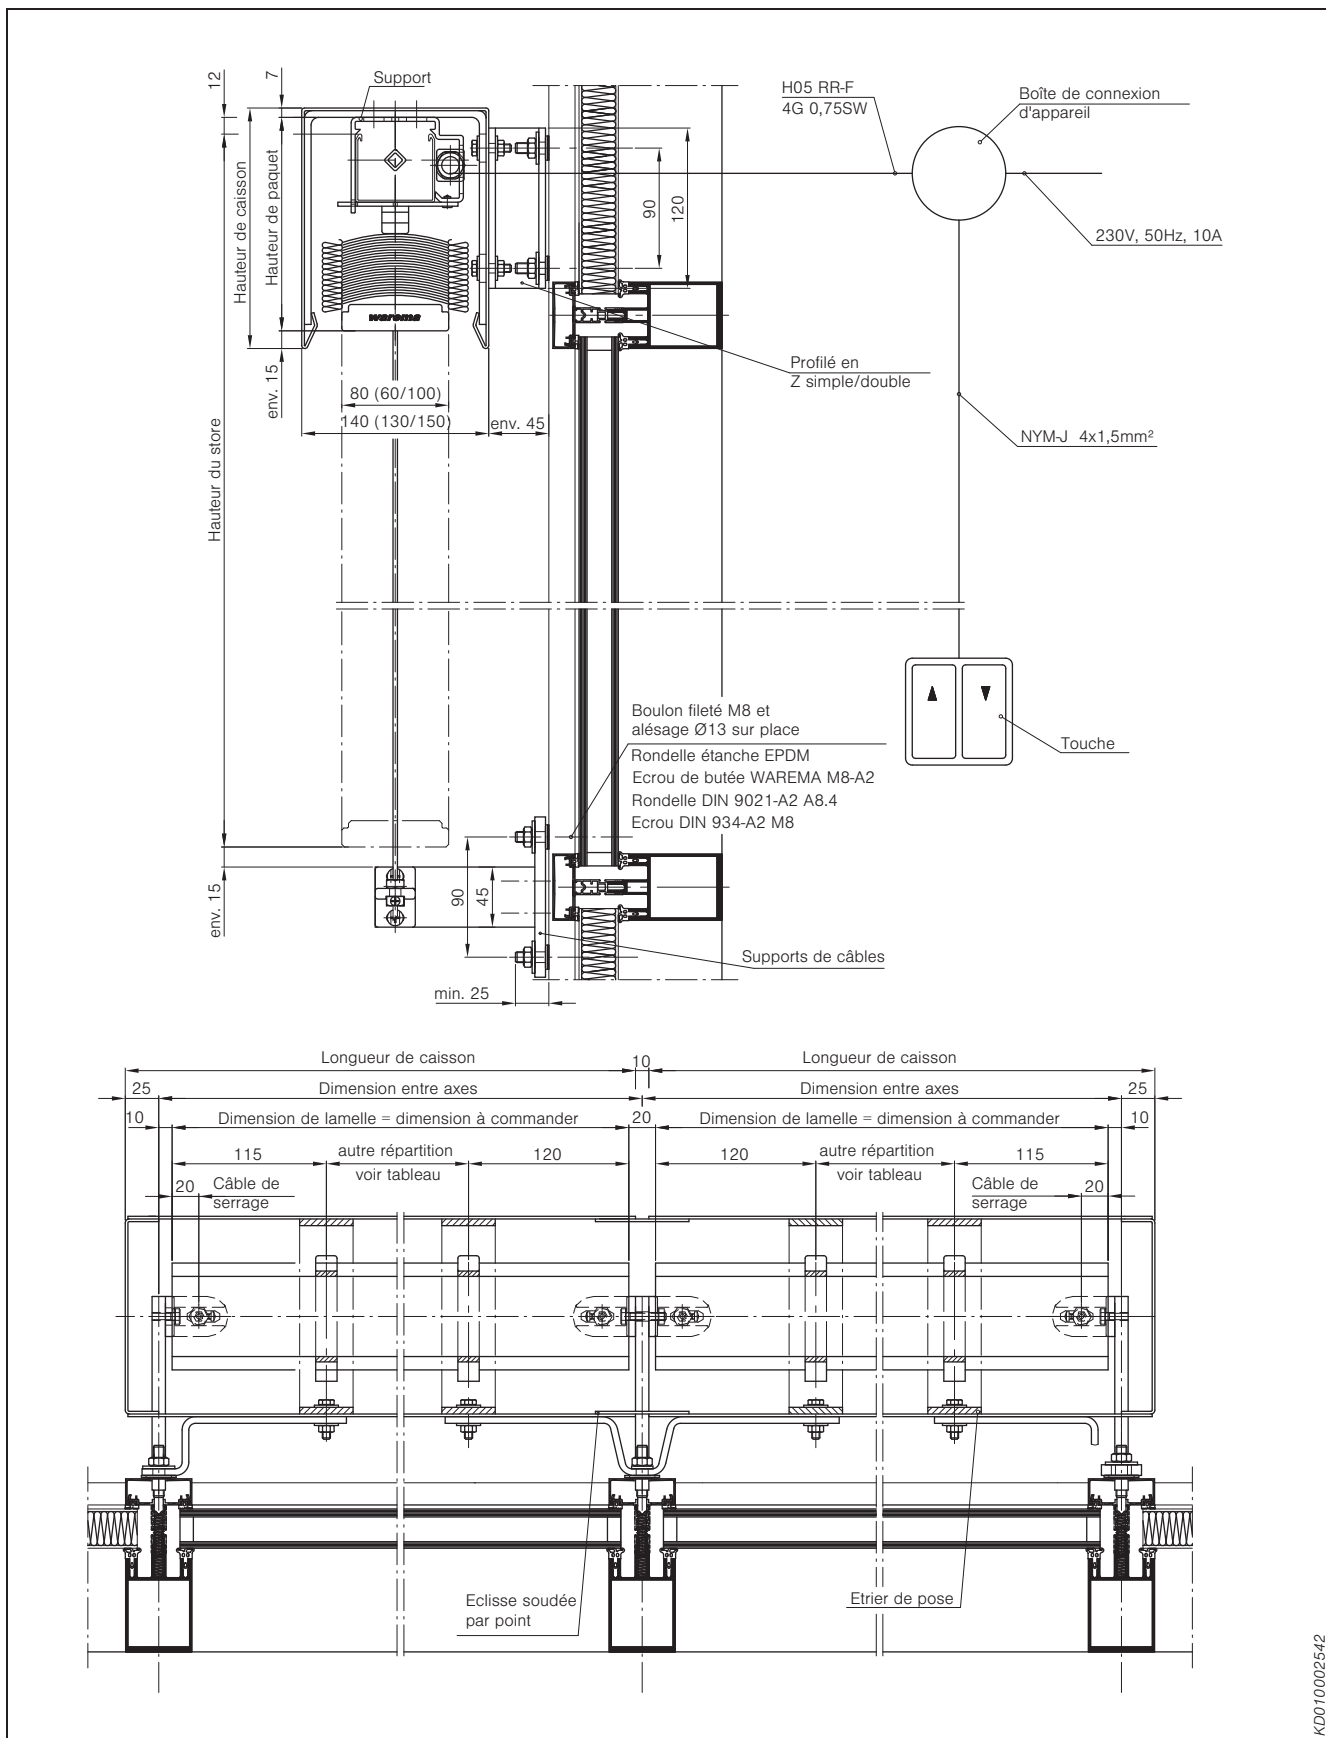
Exemple de pose brise-soleil orientables types E 60/80/100 AF à lamelles plates dans caisson en U pour façade mur rideau
